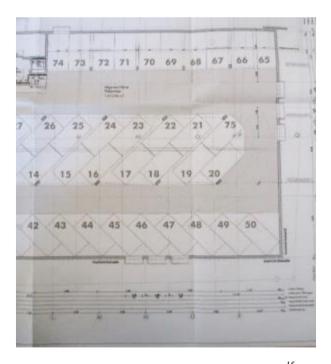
Grundriss Tiefgarage (4/4)<sup>15</sup>
